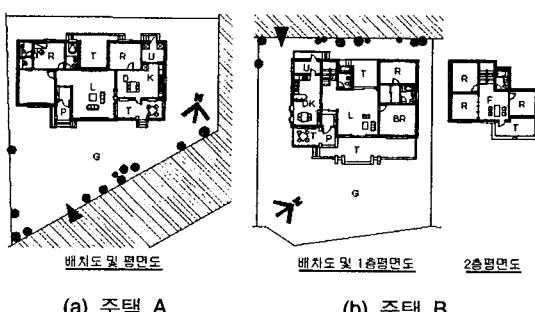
주택 A와 주택 B의 배치도 및 평면도
